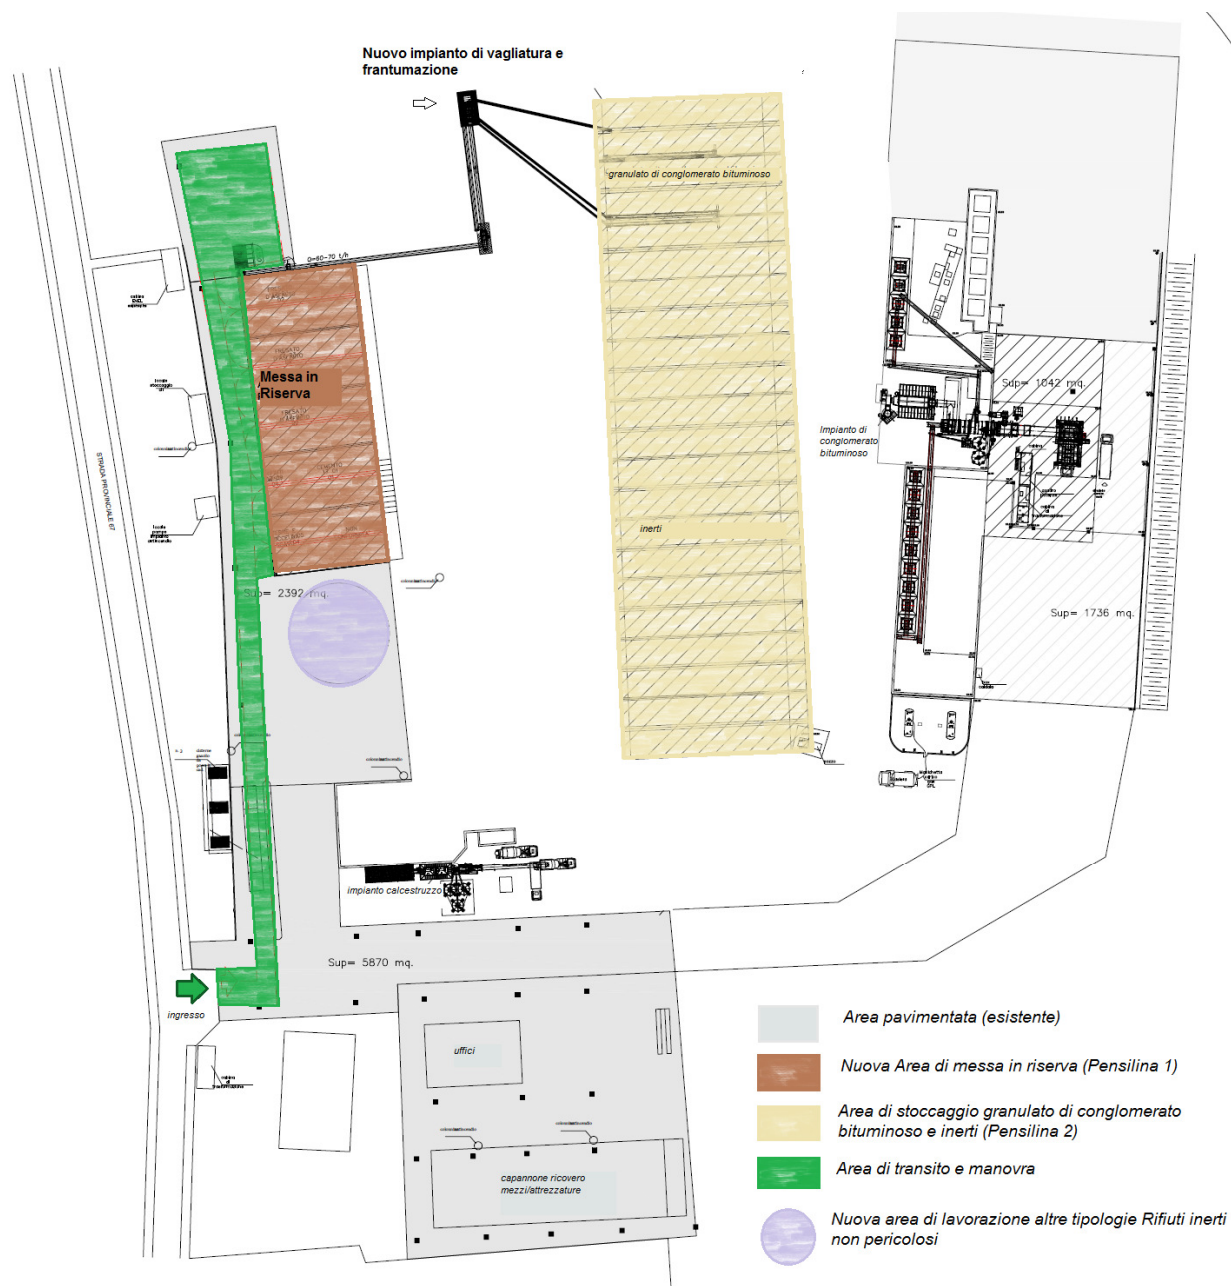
Planimetria di progetto con identificazione delle aree per il recupero dei rifiuti
